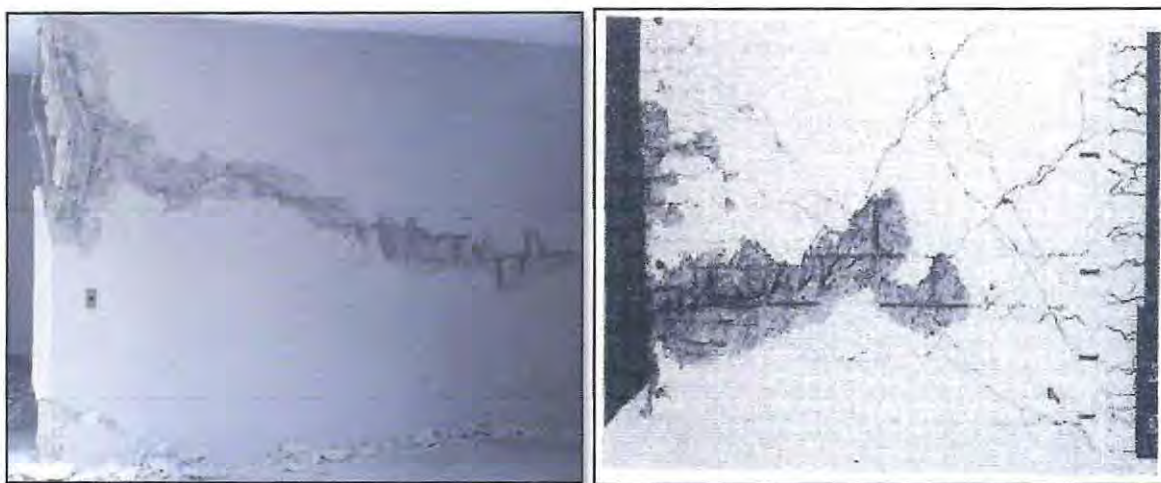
y Figura 1.18 Grietas en muro eje 9 (derecha) y muro T1 de [17] (izquierda).
